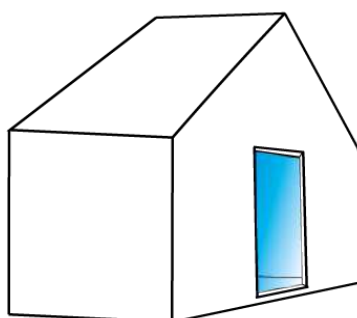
A2- Segunda alternativa telhado - forma com paredes, piso e fundo
